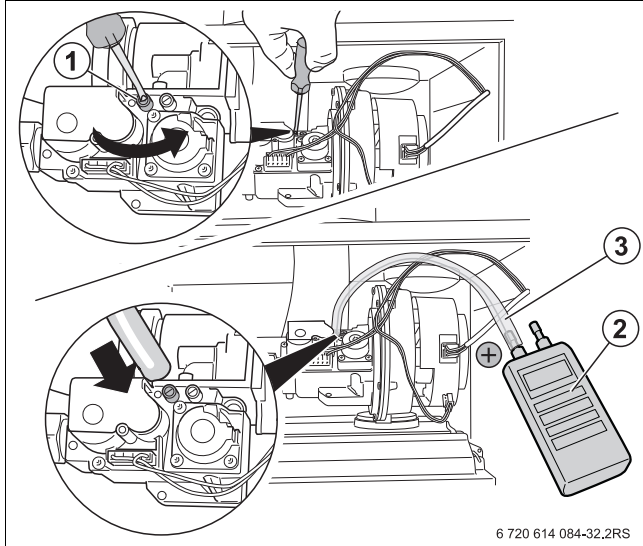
Gas-Anschlussfließdruck beim ZBR 65 messen
